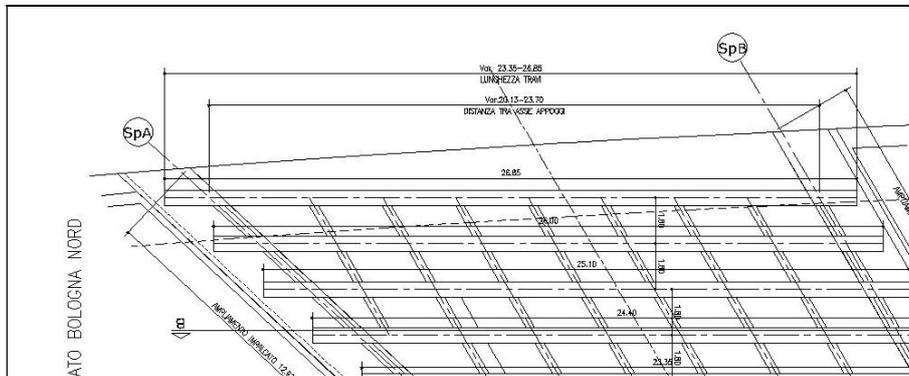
Pianta impalcato in ampliamento – Lato Nord
